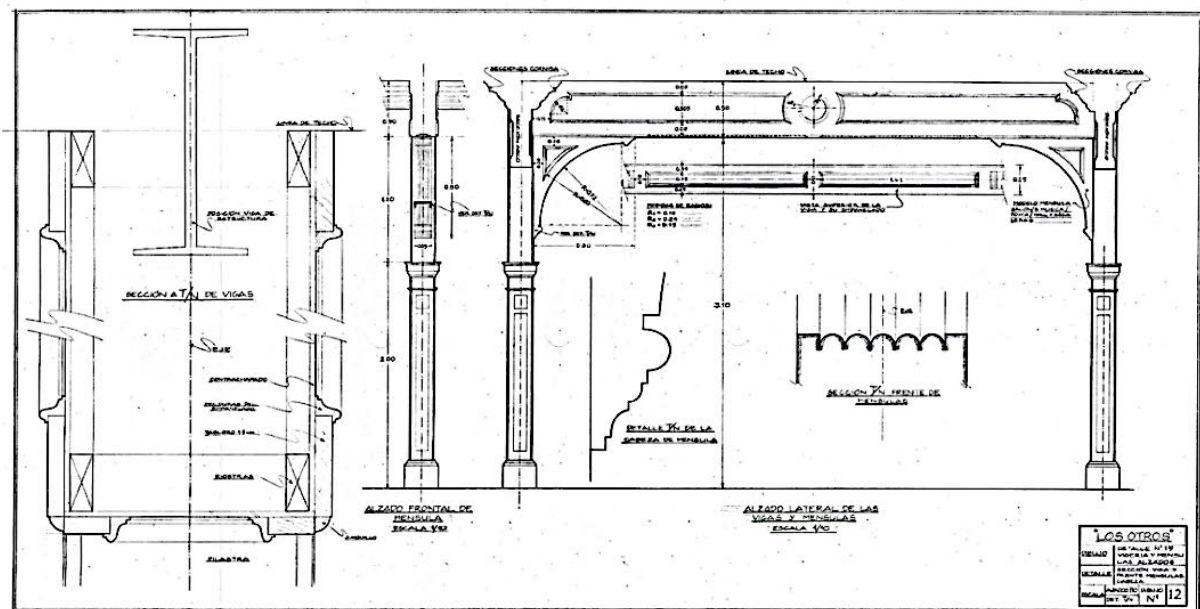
Planos. Alzado lateral de las vigas y ménsulas. Vestíbulo. *Los otros*.
